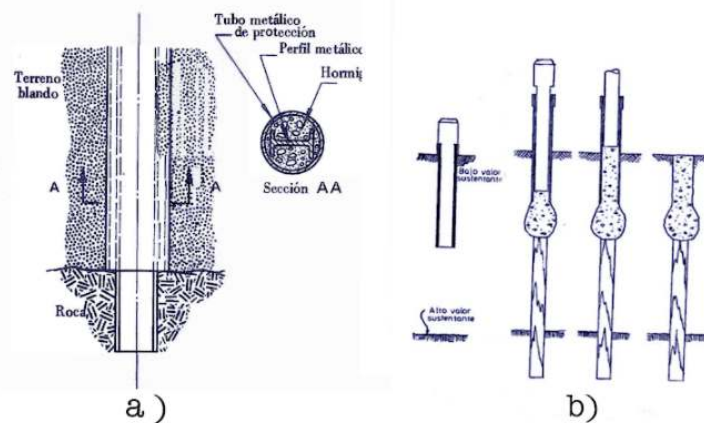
Pilotes compuestos. a) Con perfil H relleno de concreto. b) Madera-Concreto.
